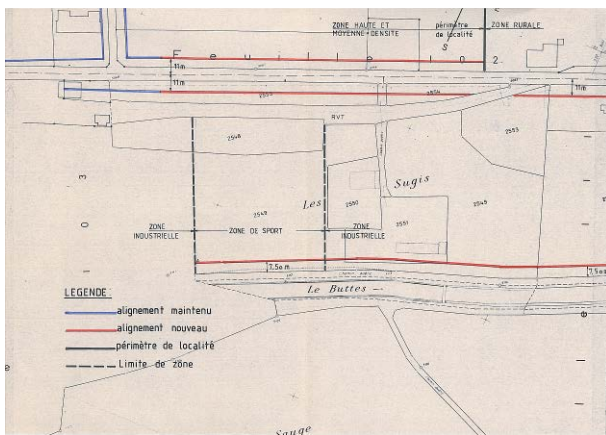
Extrait du plan d'alignement "zone industrielle" en vigueur (partie Ouest)
